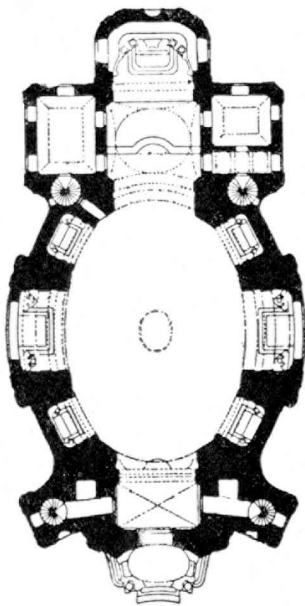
Plan kościoła S. Andrea in Quirinale w Rzymie. 1:400.
